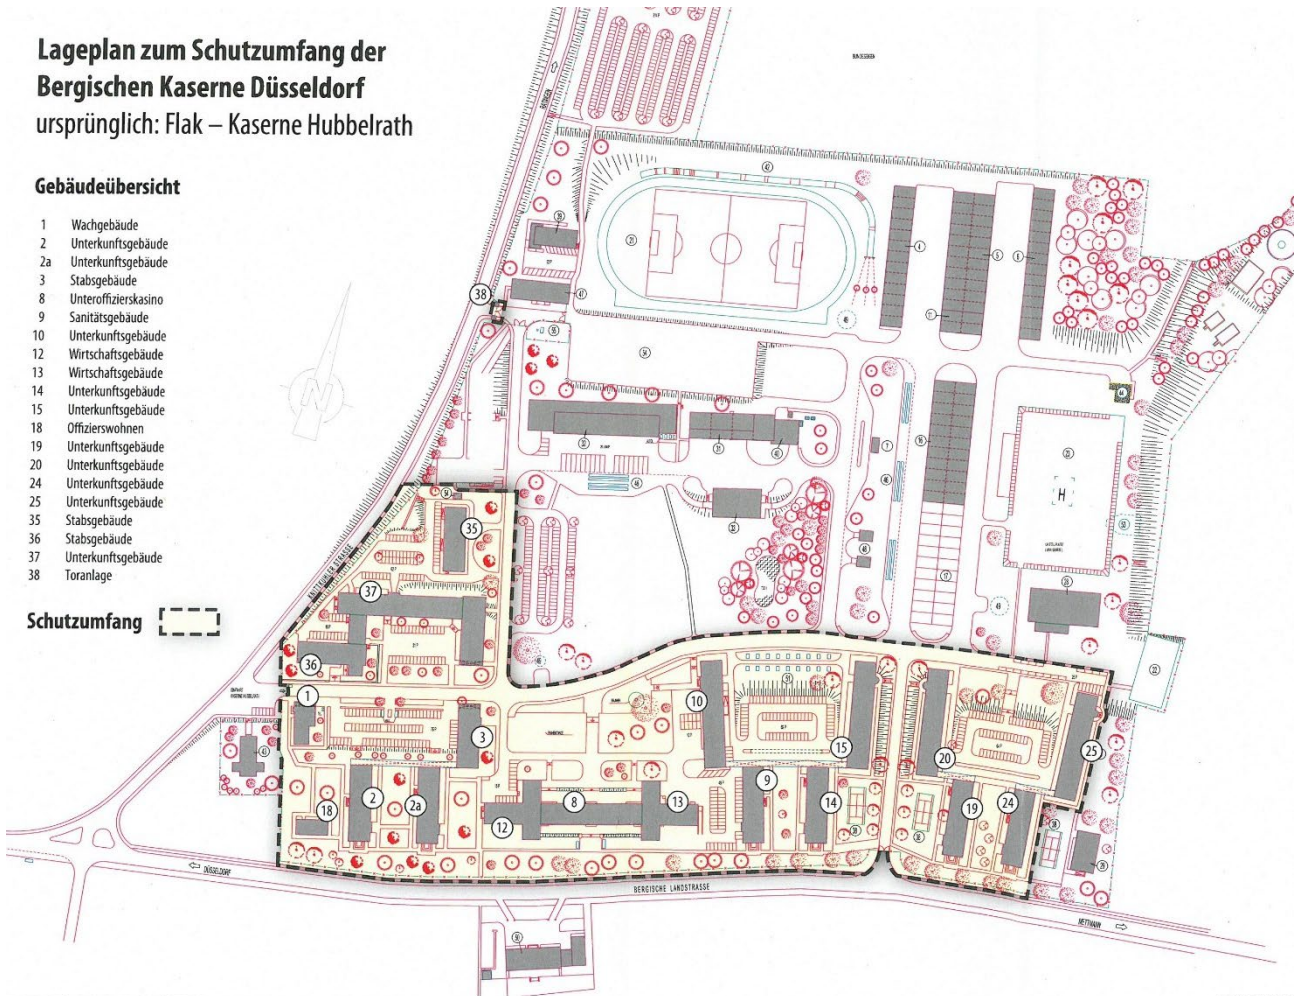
Lageplan zum Schutzzumfang der Bergischen Kaserne Düsseldorf (ist den Plangrundlagen beigelegt)
